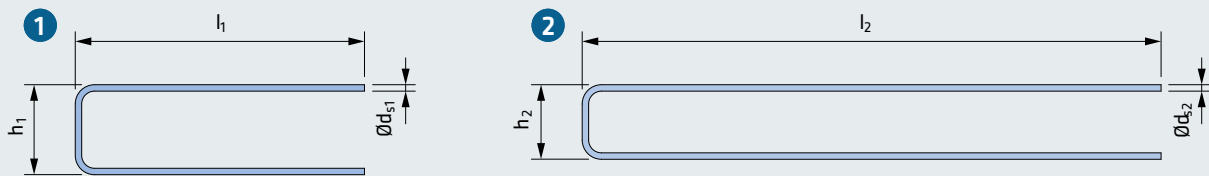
Bauseitige Bewehrung für TreDo PD30 am Bauteilrand
